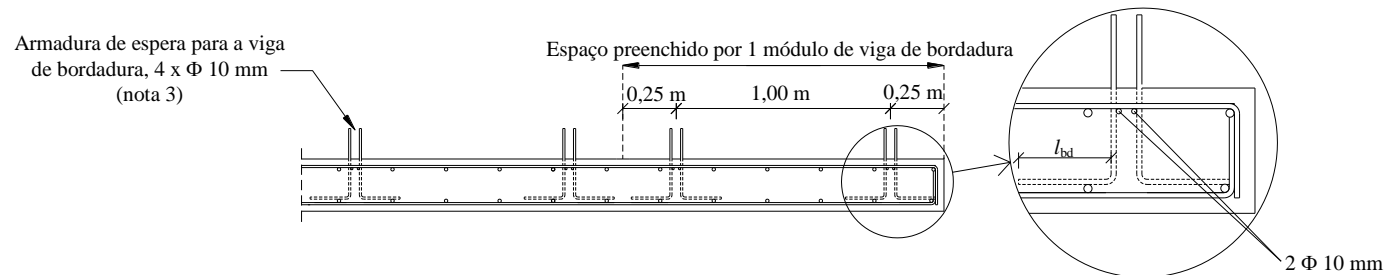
Secção longitudinal da laje de betão armado (secção AA).
